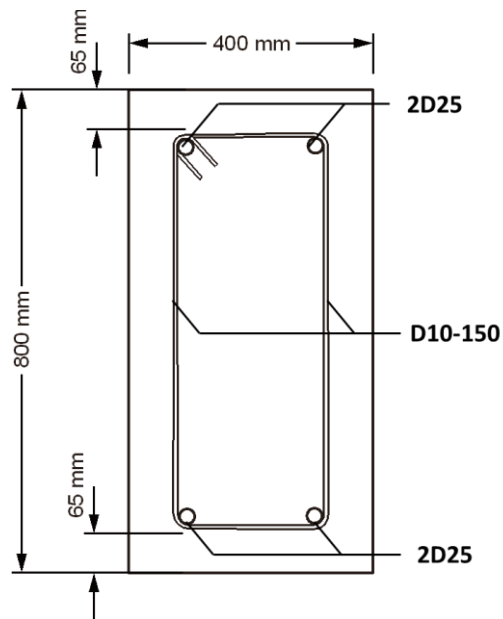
Detail tulangan potongan pelat dermaga arah melintang
